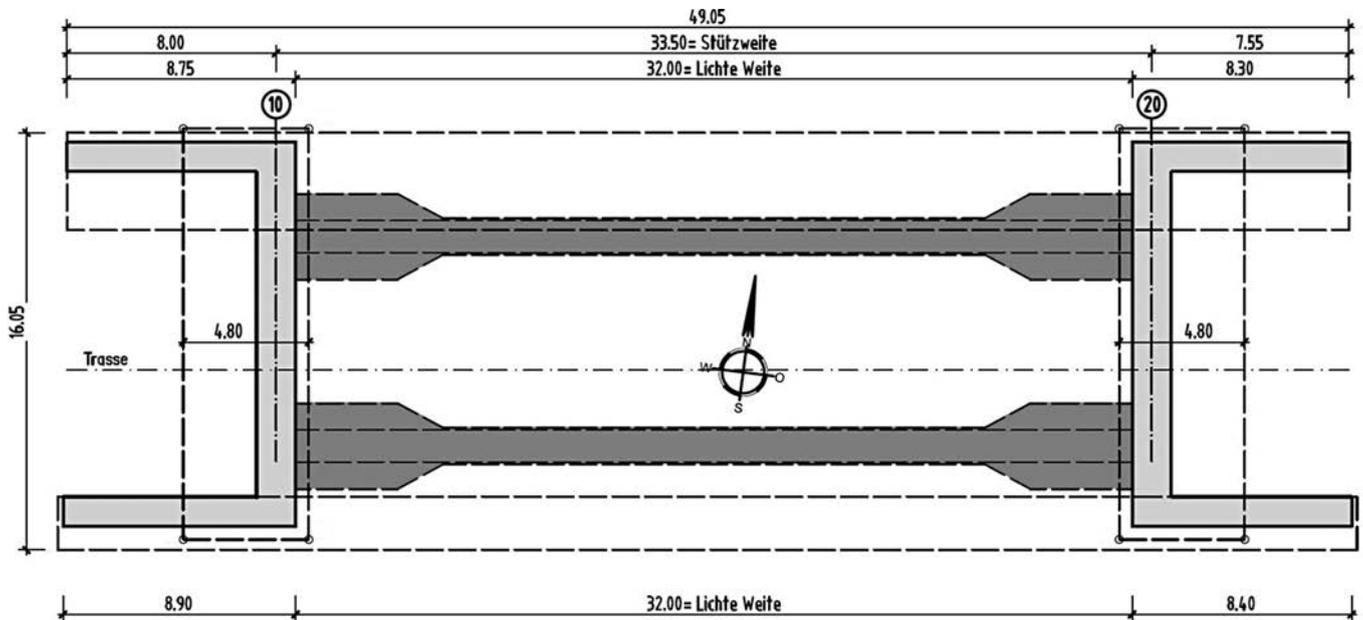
VFT-Rahmen als Haupttragwerk im Grundriss vor dem Auflegen der Segmente (SSF Ingenieure)
